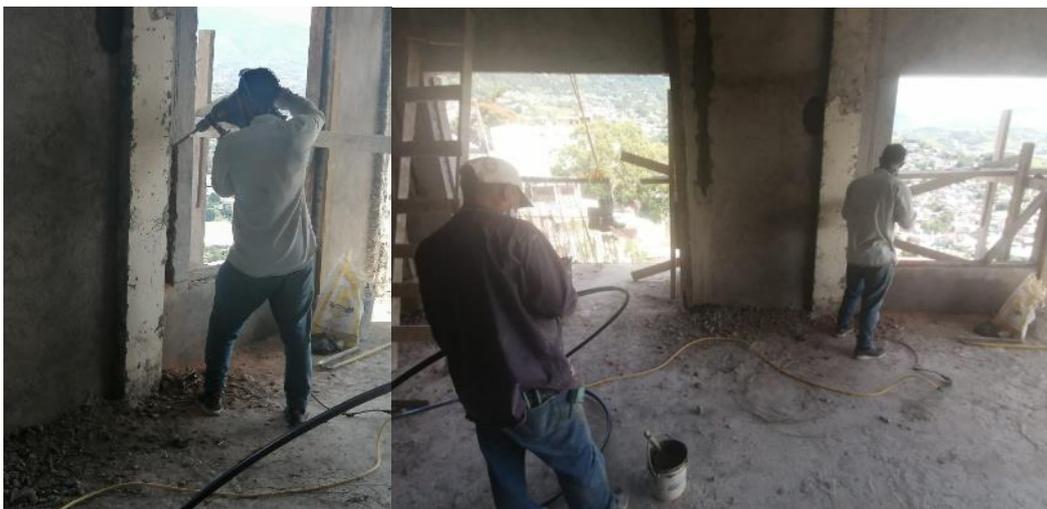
Construcción pared frontal zona habitacional 1
